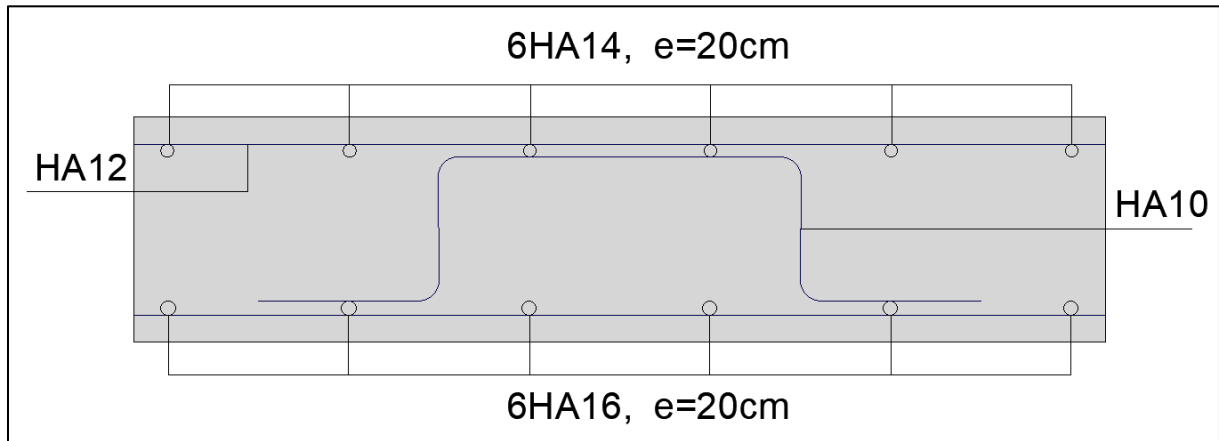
Ferrailage de la dalle (coupe transversale)
